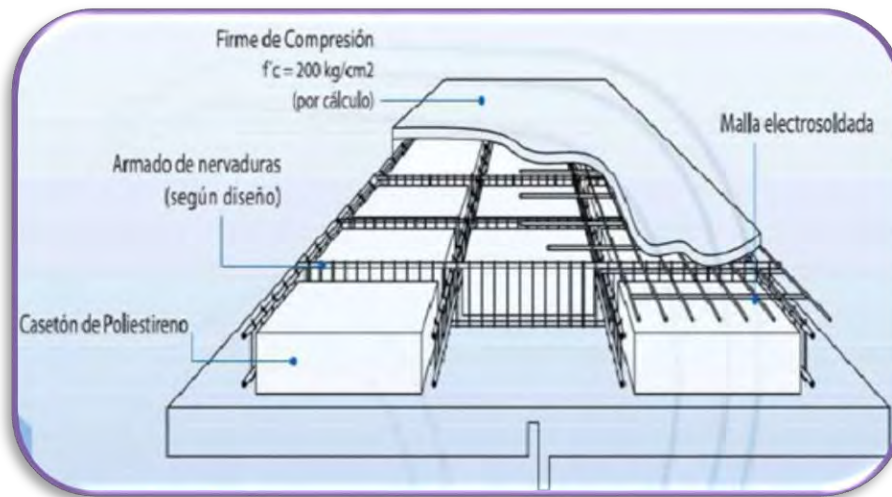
Detalle de Losa Reticular <http://www.arqhys.com/articulos/losas-nervadas-reticulares.html>
